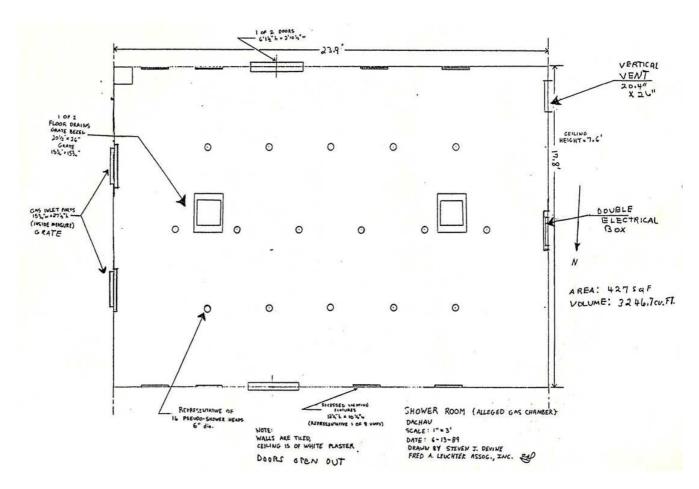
Cuarto de duchas (supuesta cámara de gas), Dachau. Vista en planta del cuarto de duchas en la Baracke X, del campo de Dachau.
